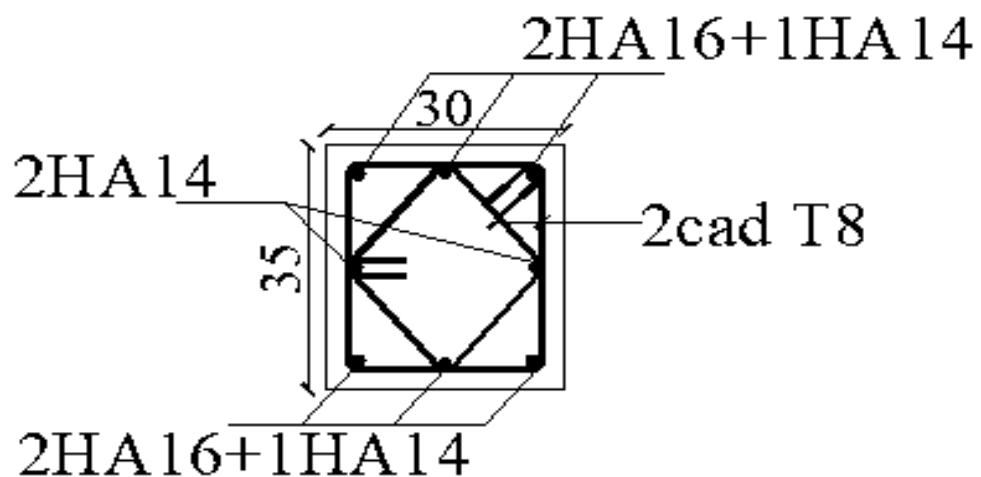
Ferrailage des poteaux 30 x 35
